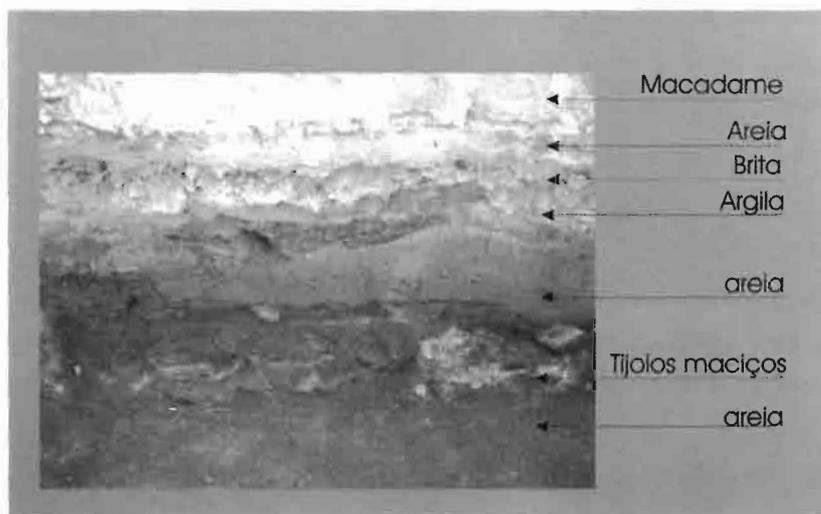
Vista da EA4 tijolos maciços com arranjo de piso. Fonte UFPE e Fundação Seridó.
